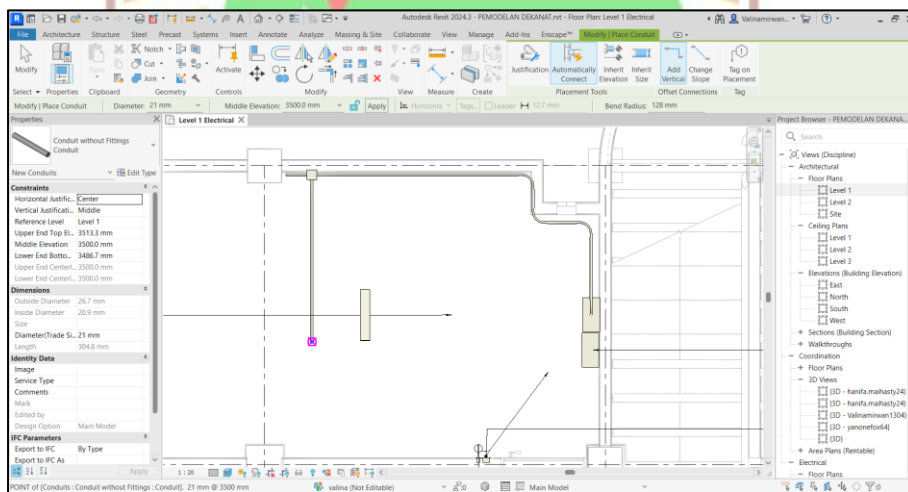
Menambahkan Conduit pada Pemodelan Bangunan
